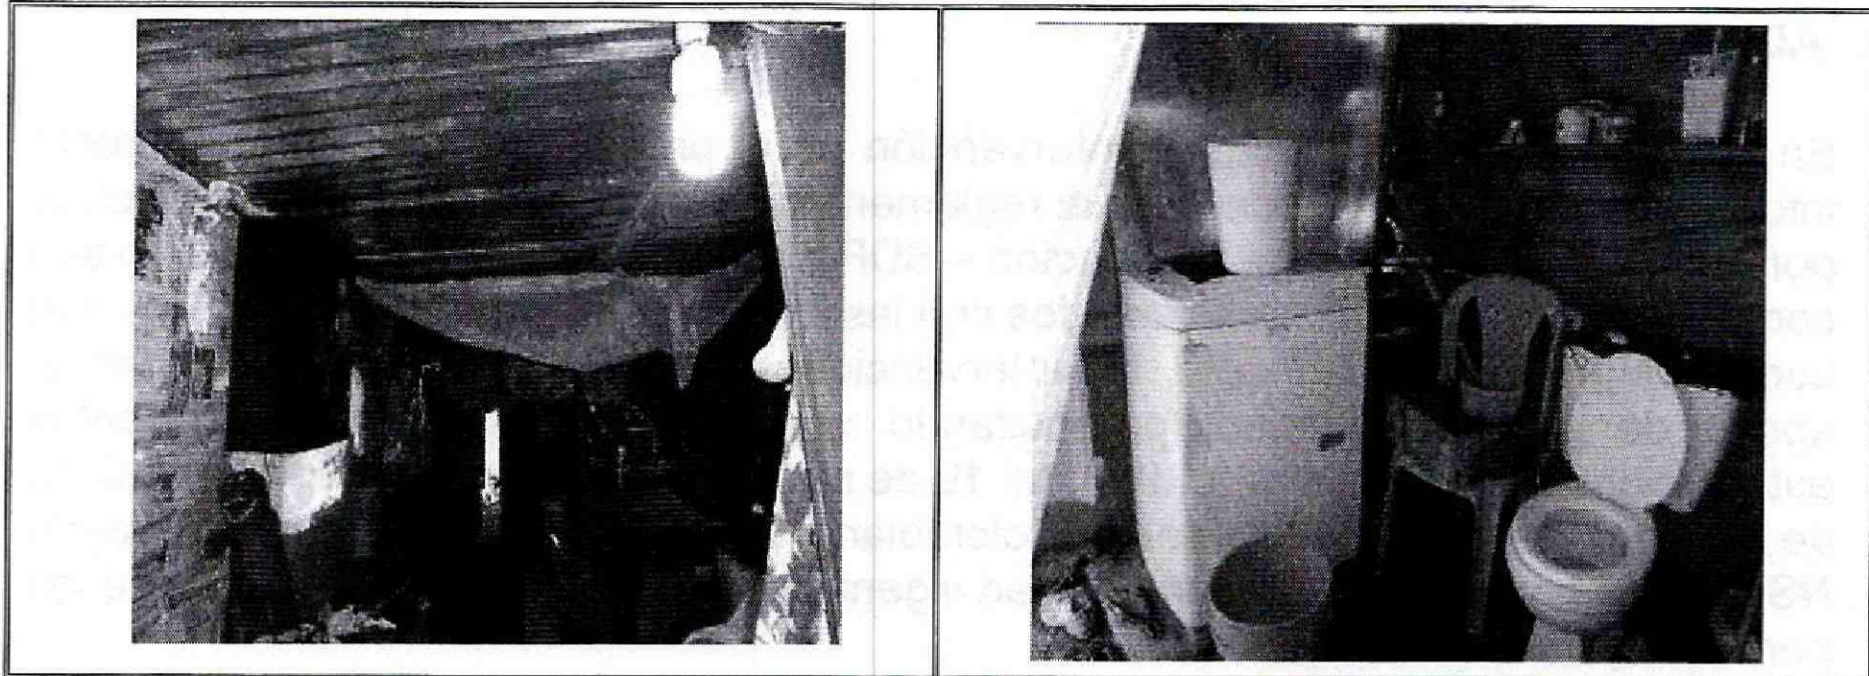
y 8. Vista interior de la vivienda evaluada
